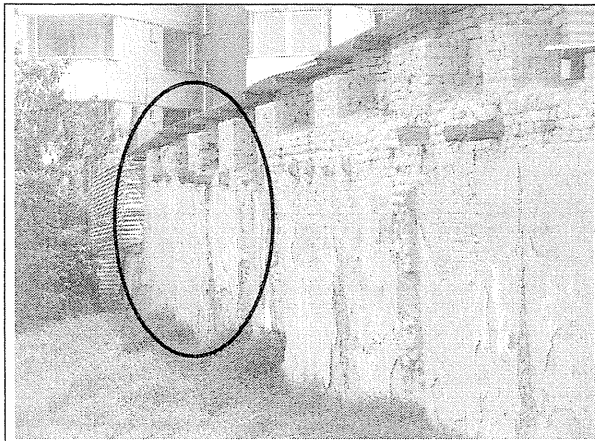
Fisuras y desprendimientos de adobes en el muro de lindero del costado oriental.
